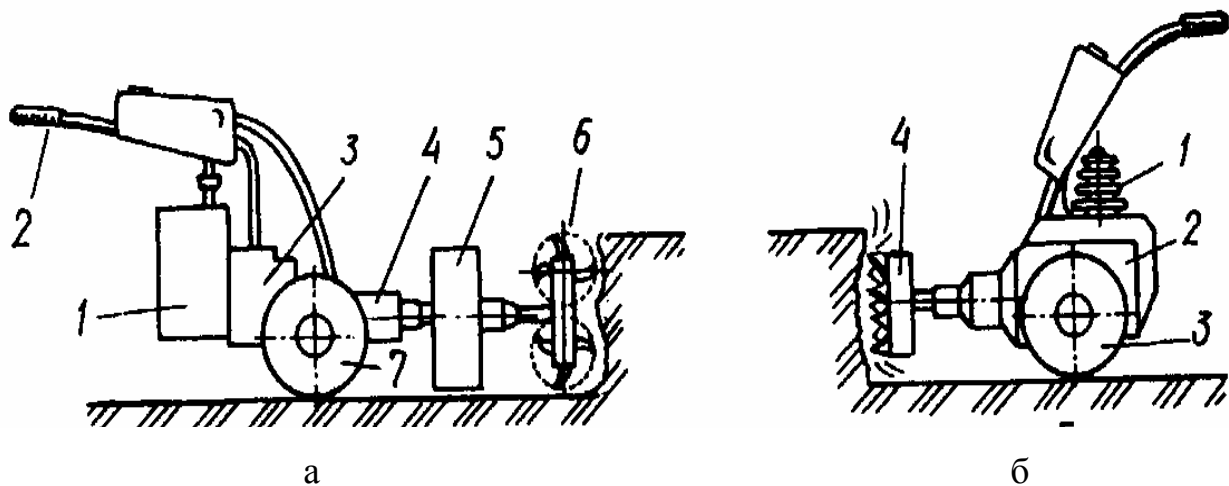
Ручний механізований землерийно-транспортувальний інструмент:
